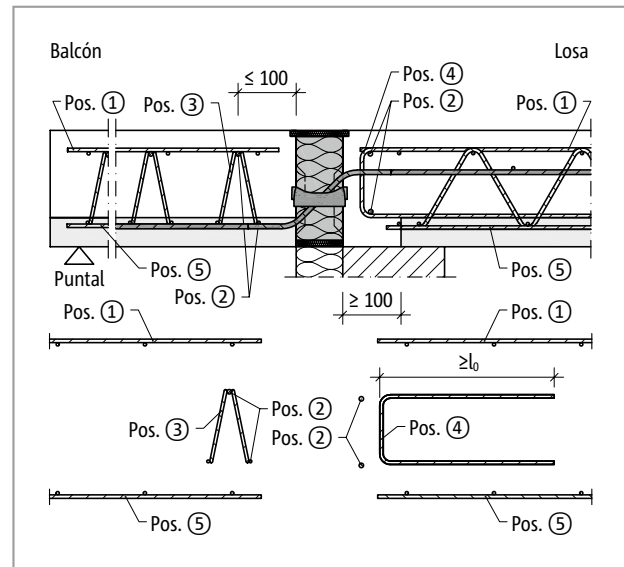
Schöck Isokorb® T tipo Q-V6 hasta Q-V10: Armadura in situ con viga de celosía
